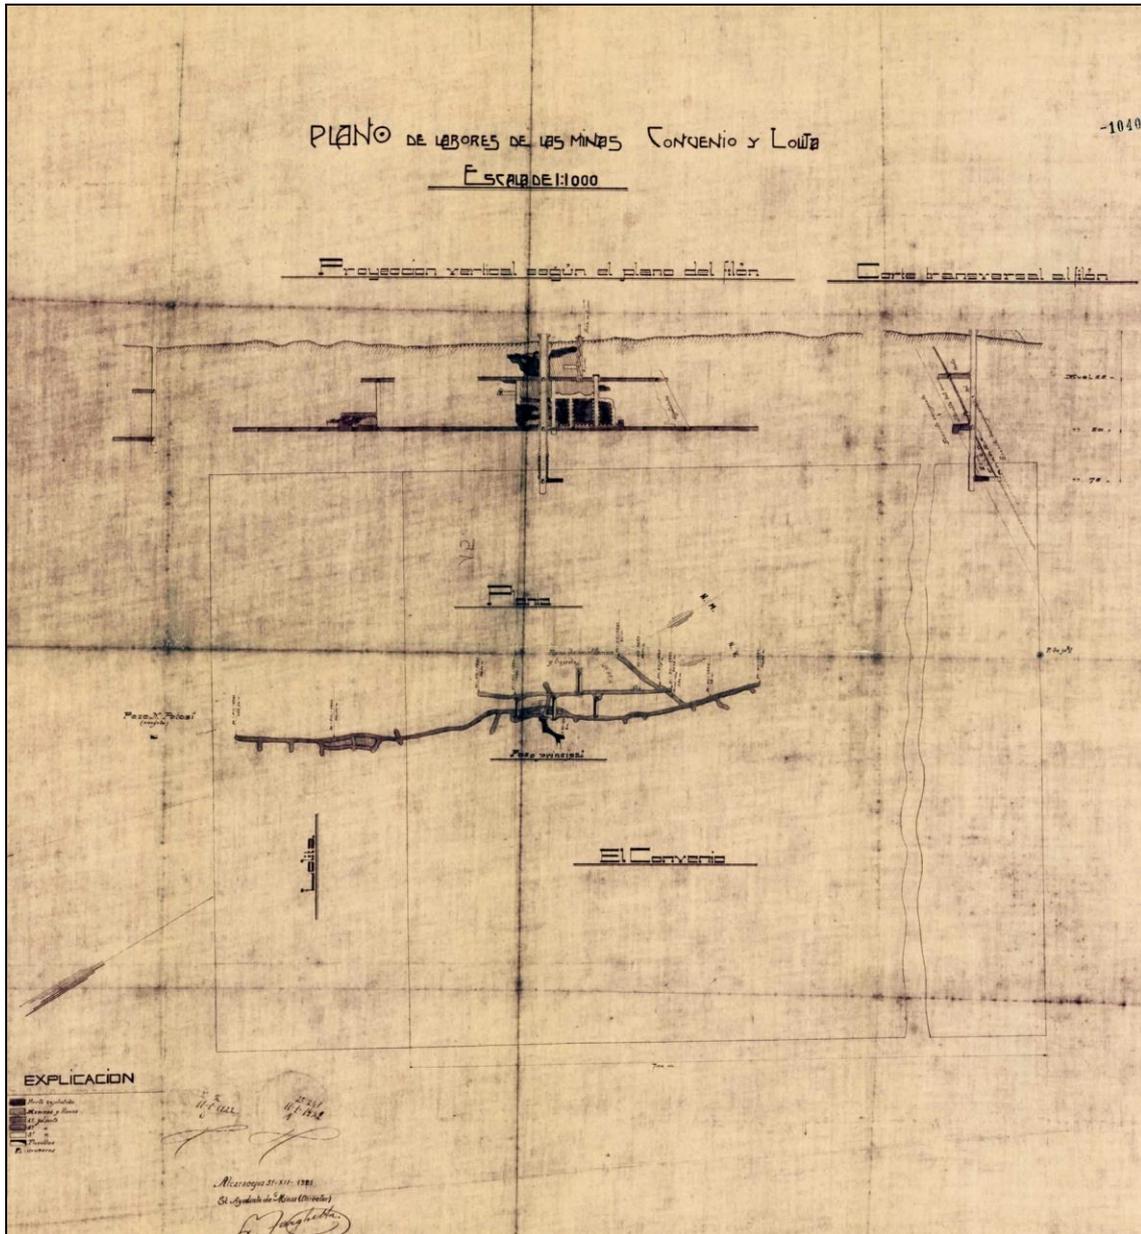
Plano de labores de las minas El Convenio y Lolita, 1922 (IGME)
